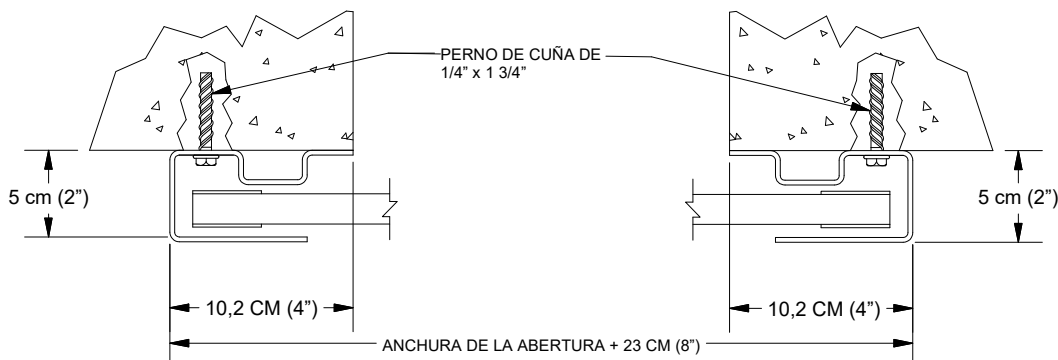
JAMBAS DE CONCRETO Y MAMPOSTERÍA
